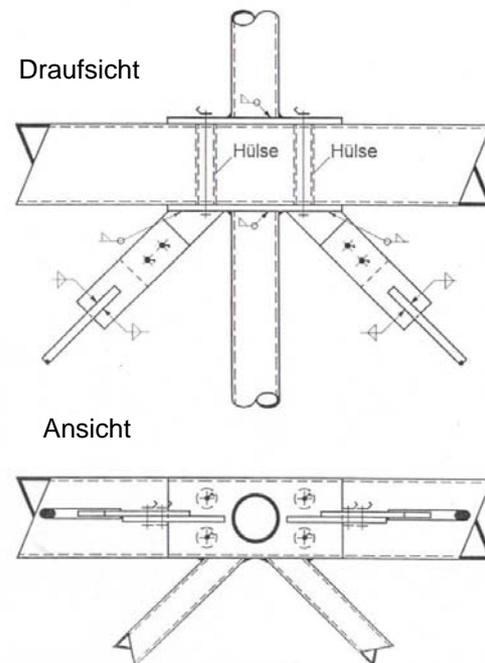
Dachverbandsknoten am Obergurt eines Fachwerkbinders aus Rechteck-Hohlprofilen [12]
